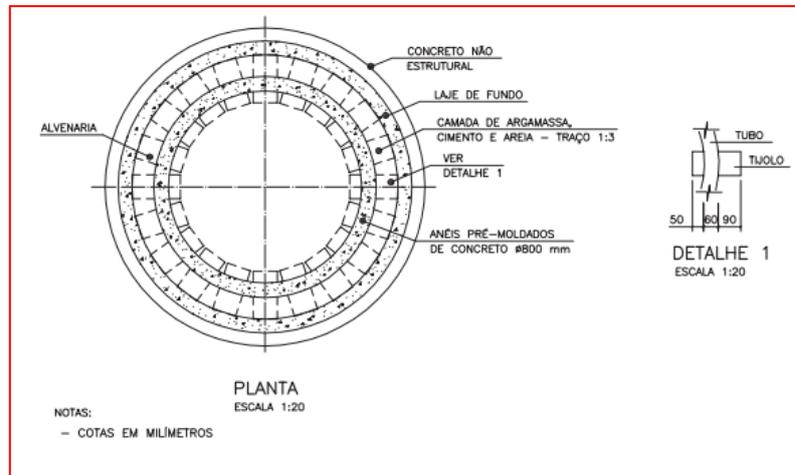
Execução de PV - tipo A - conforme SANEPAR - planta - Fonte: SANEPAR
